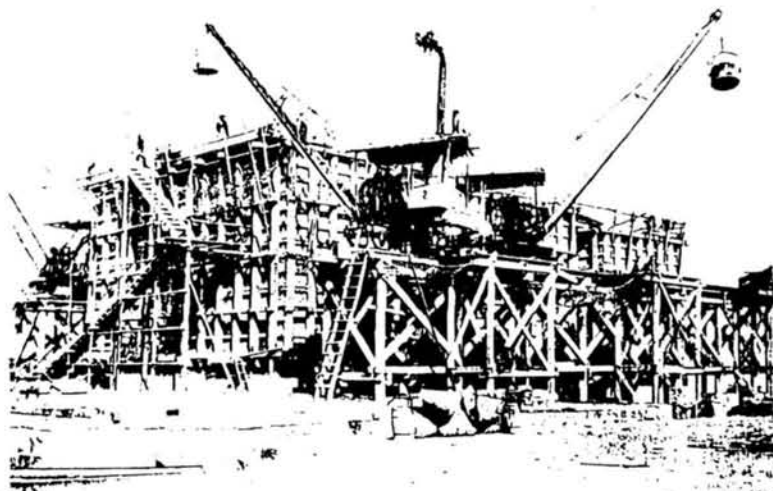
第二期小樽築港工事、鉄筋コンクリート函塊製作施工中<sup>10)</sup>
